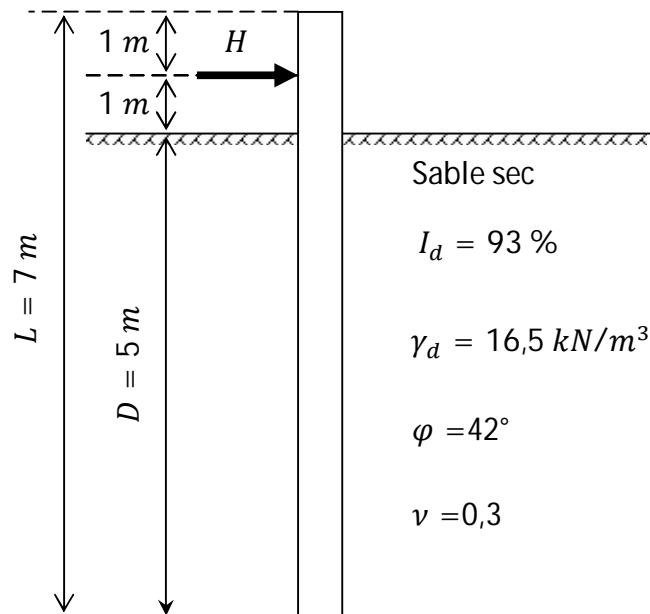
Dimensions du pieu prototype et caractéristiques géotechniques du sable
